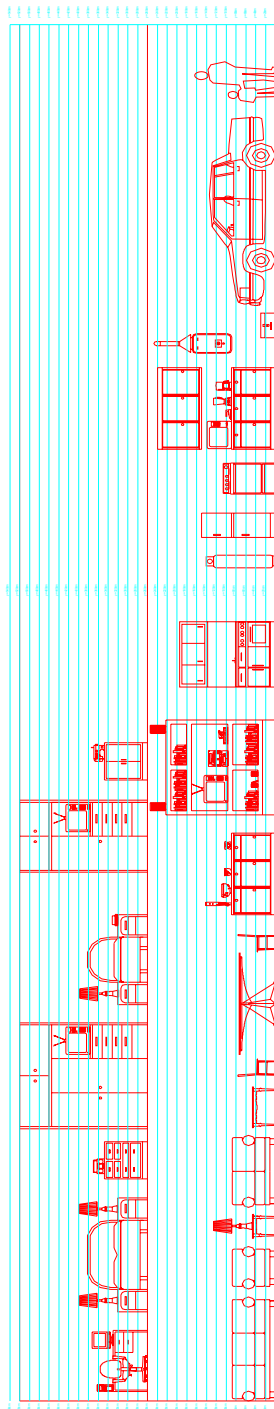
Menaje para la vivienda tipo IV (dos plantas)
